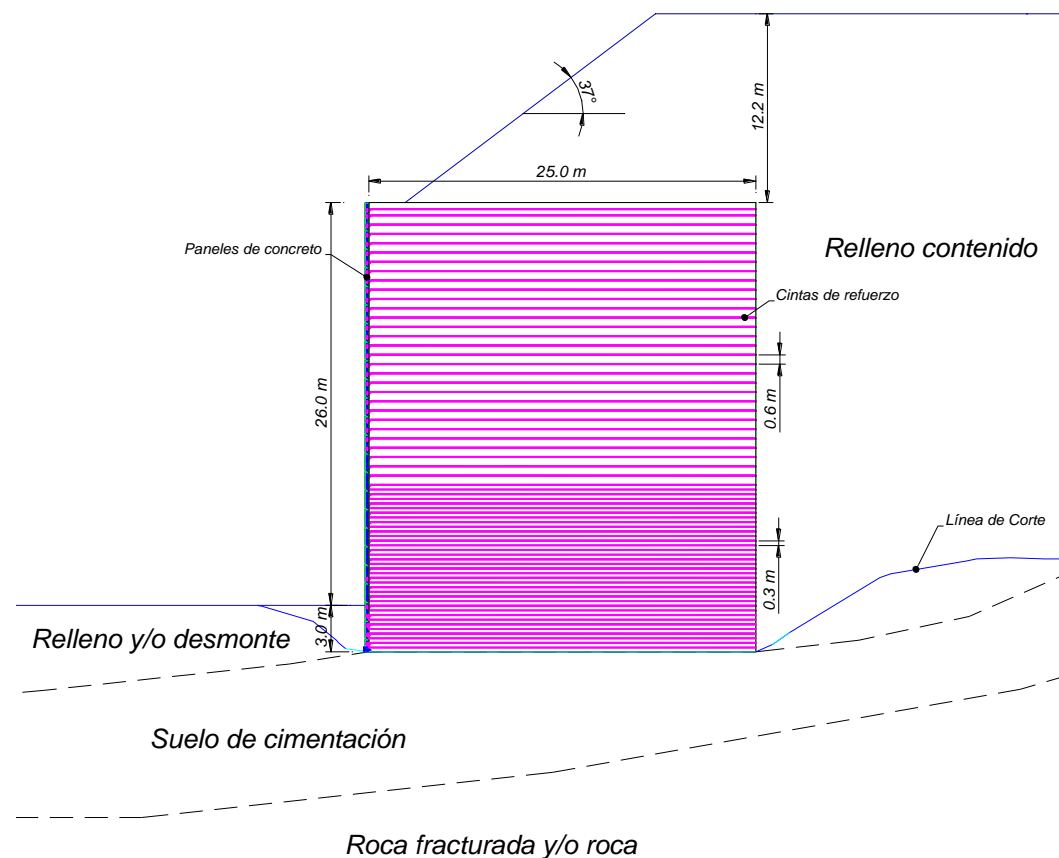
Sección transversal de muro de suelo reforzado de gran altura.
